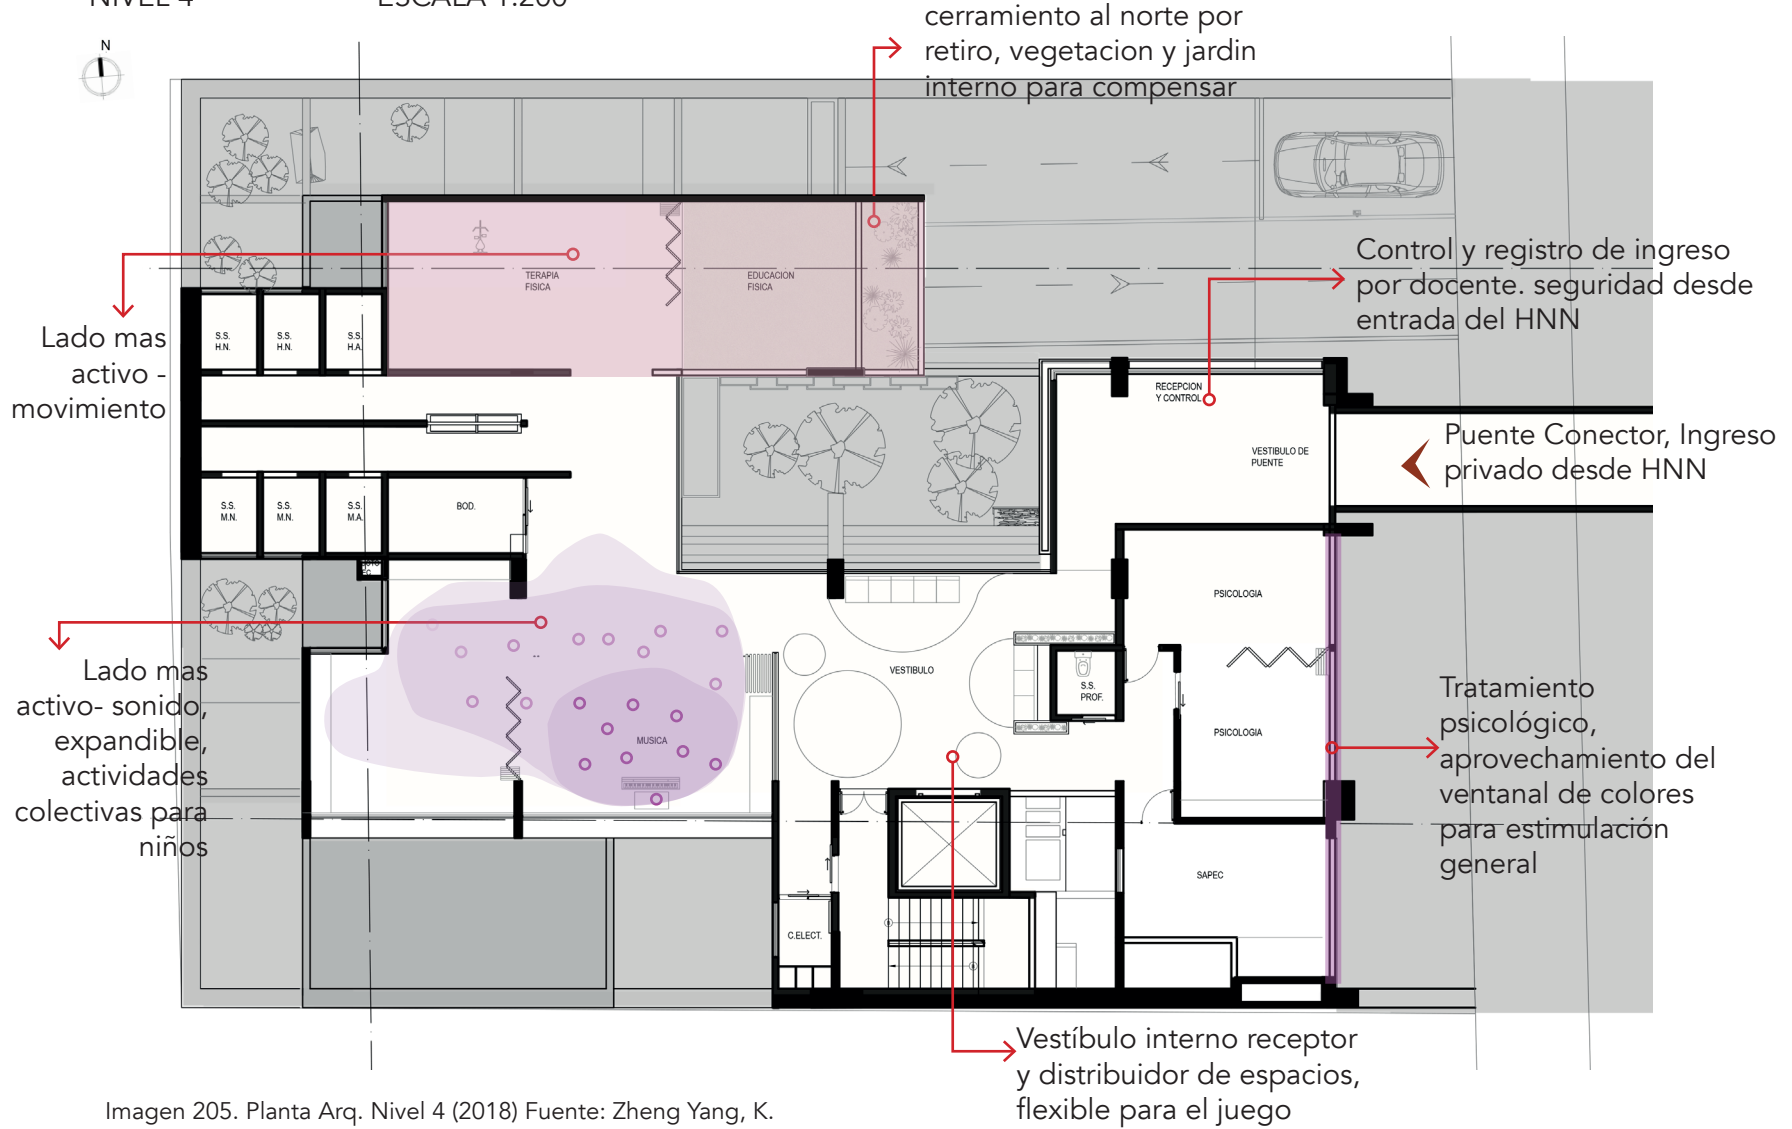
Planta Arq. Nivel 4 (2018) Fuente: Zheng Yang, K.
